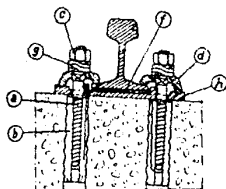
FIJACION DEL RIEL SOBRE EL DURMIENTE B53. DISPOSICION CON PLACA METALICA DE APOYO.
